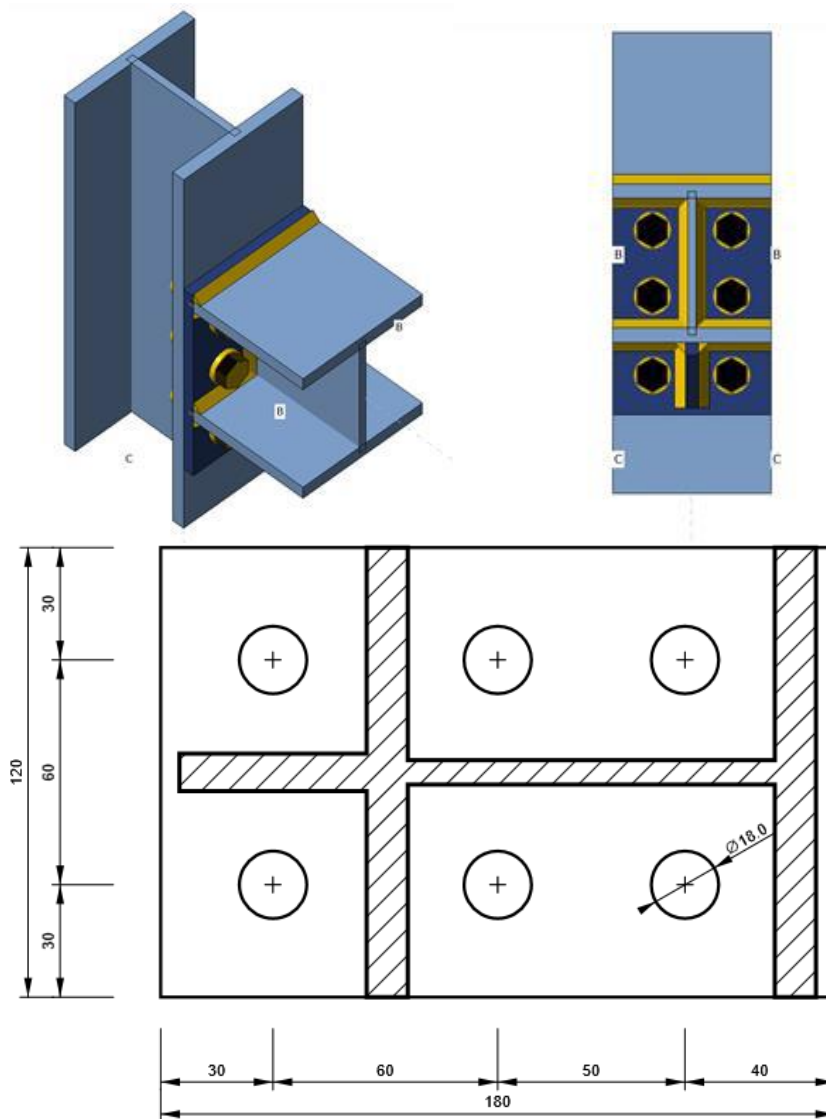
Conexiones entre vigas y pilares en 3D y 2D. Fuente: Resultante del cálculo
